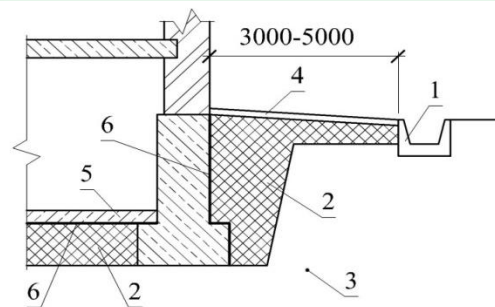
Конструкции водонепроницаемой отмостки вокруг зданий:
